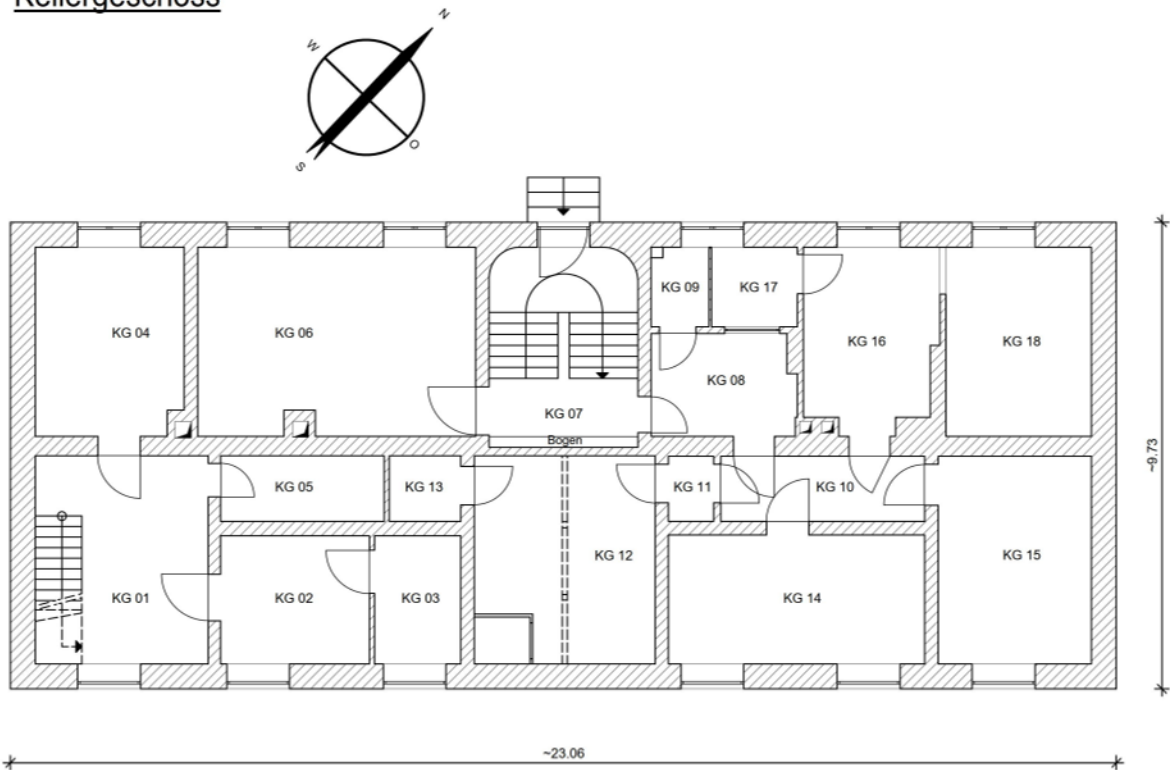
Skizze Grundriss Kellergeschoss
